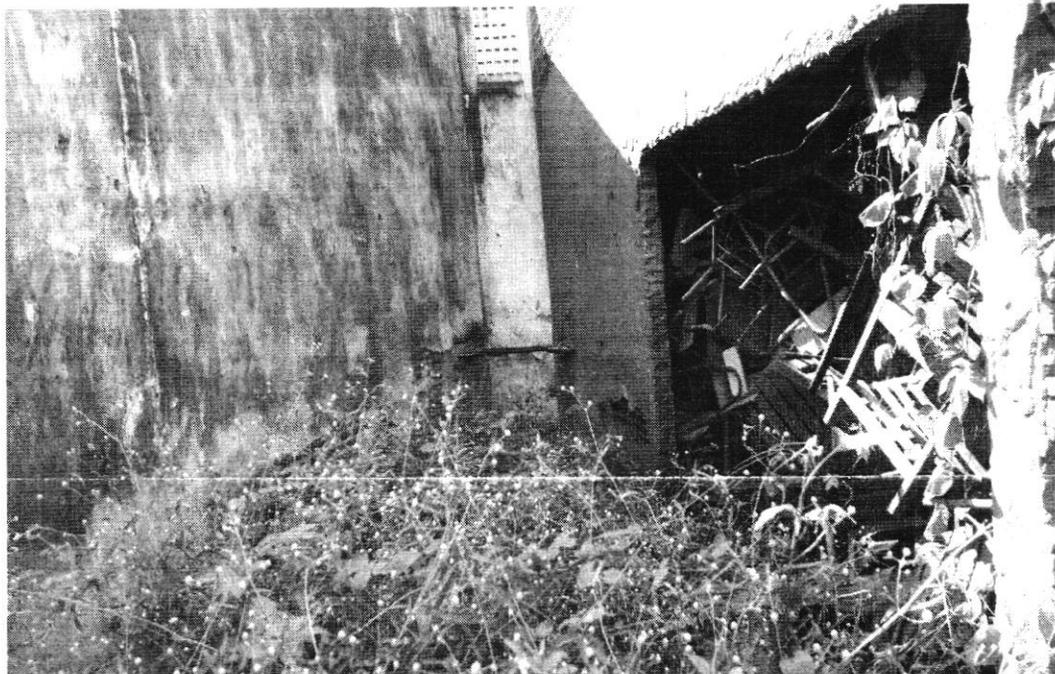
DETALHE DO PORTÃO DE ENTRADA – PARTE INTERNA
